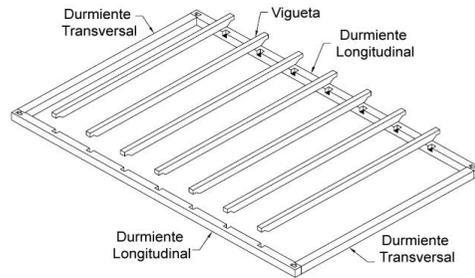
Sistema aporticado. Componentes del forjado⁵
